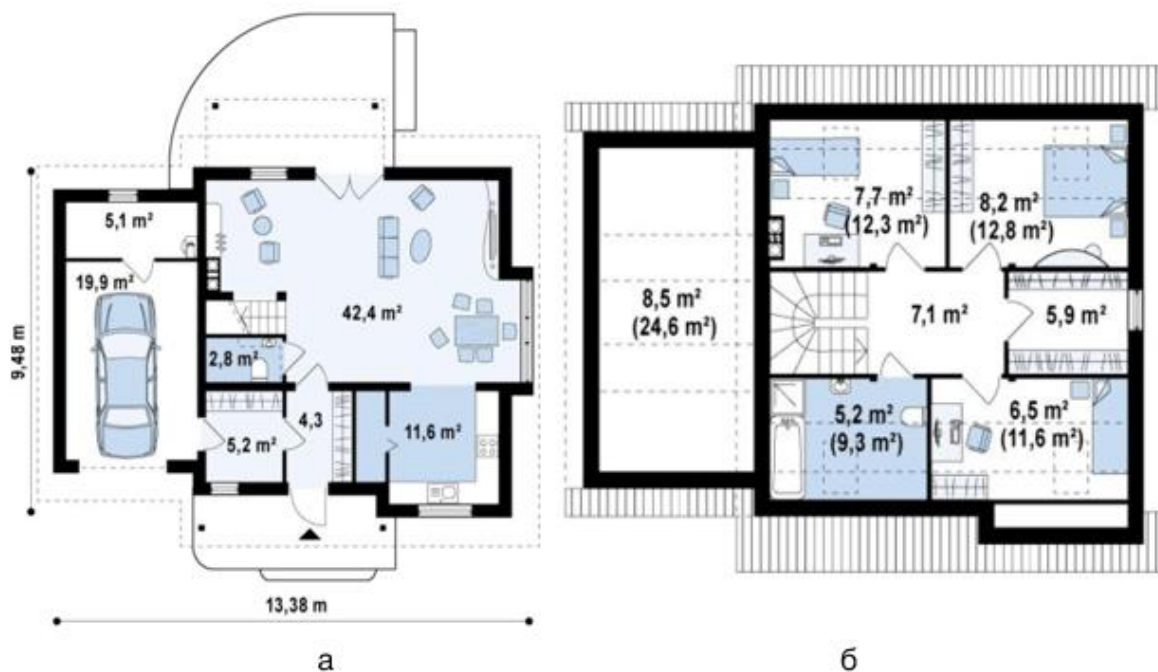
План частного дома: а - 1 этаж, б - 2 этаж
